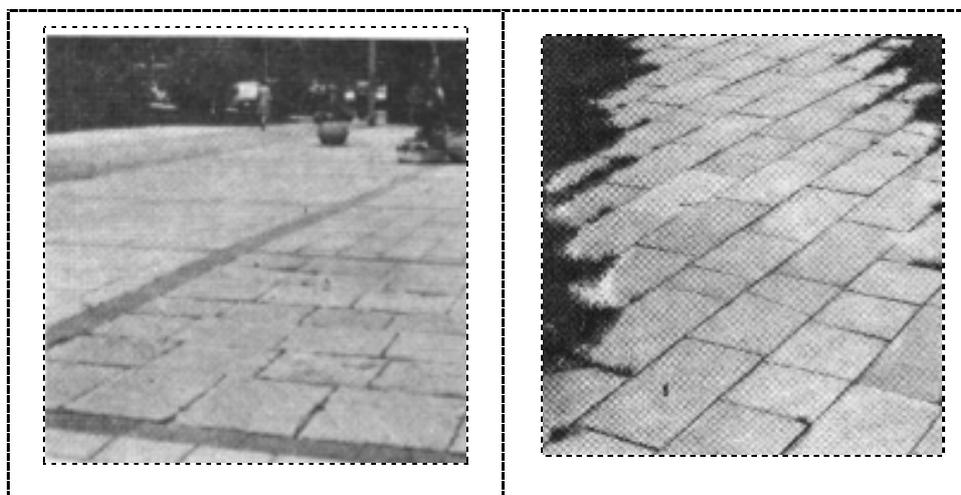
Exemple de diversification dans les façades de revêtement de sol.
